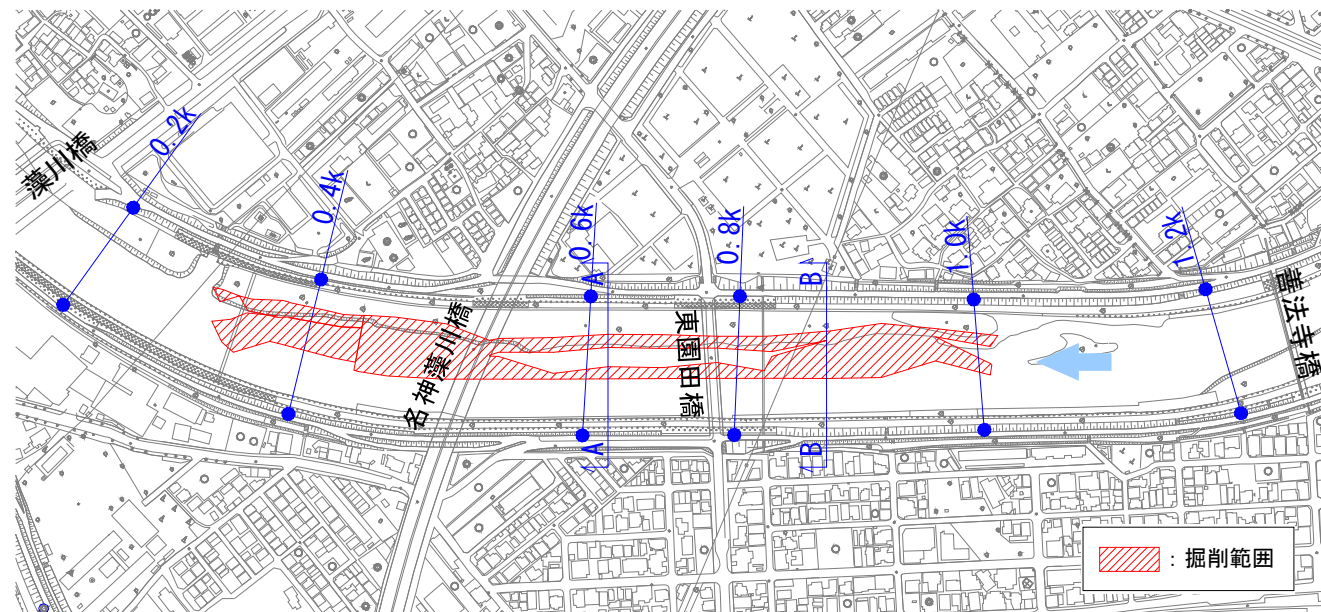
弥生ヶ丘・善法寺地区 平面図
